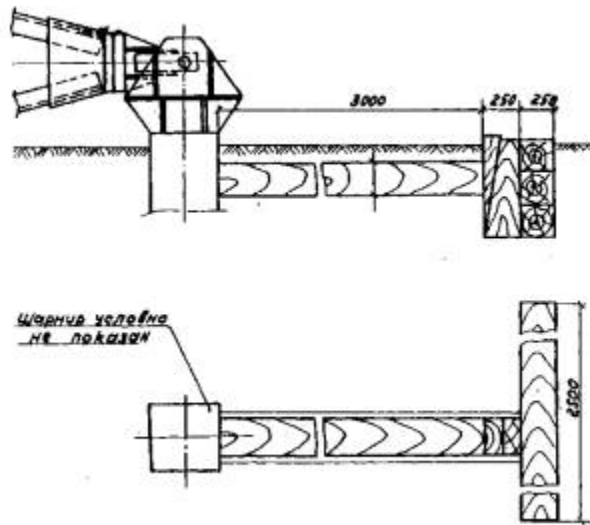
Узел раскрепления Фундамента от сдвига при установке опор типа ПН-750.
